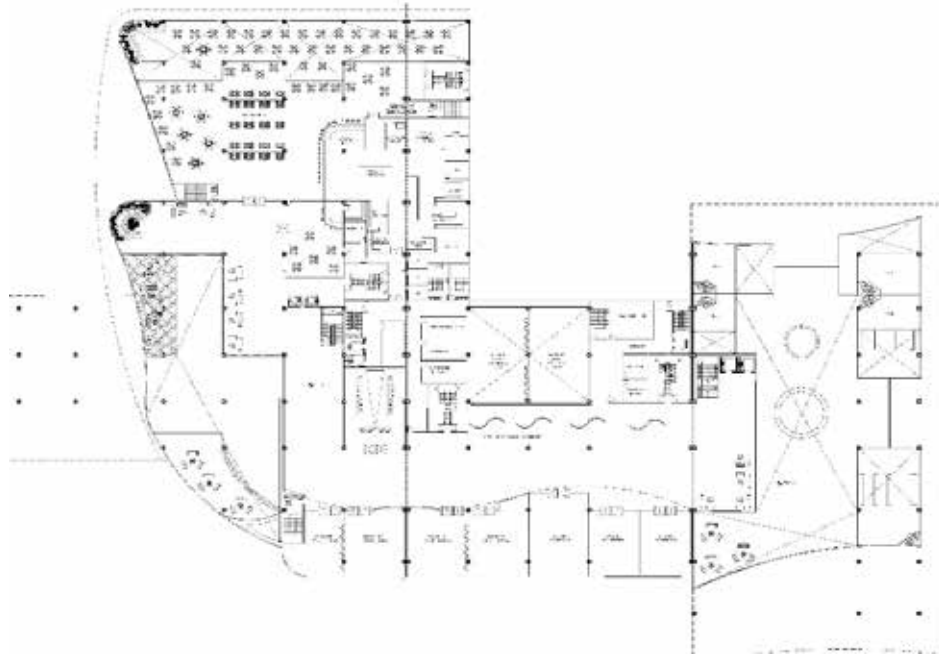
Planta Nivel 1 +0.30 Autora: Cáceres (2017).
